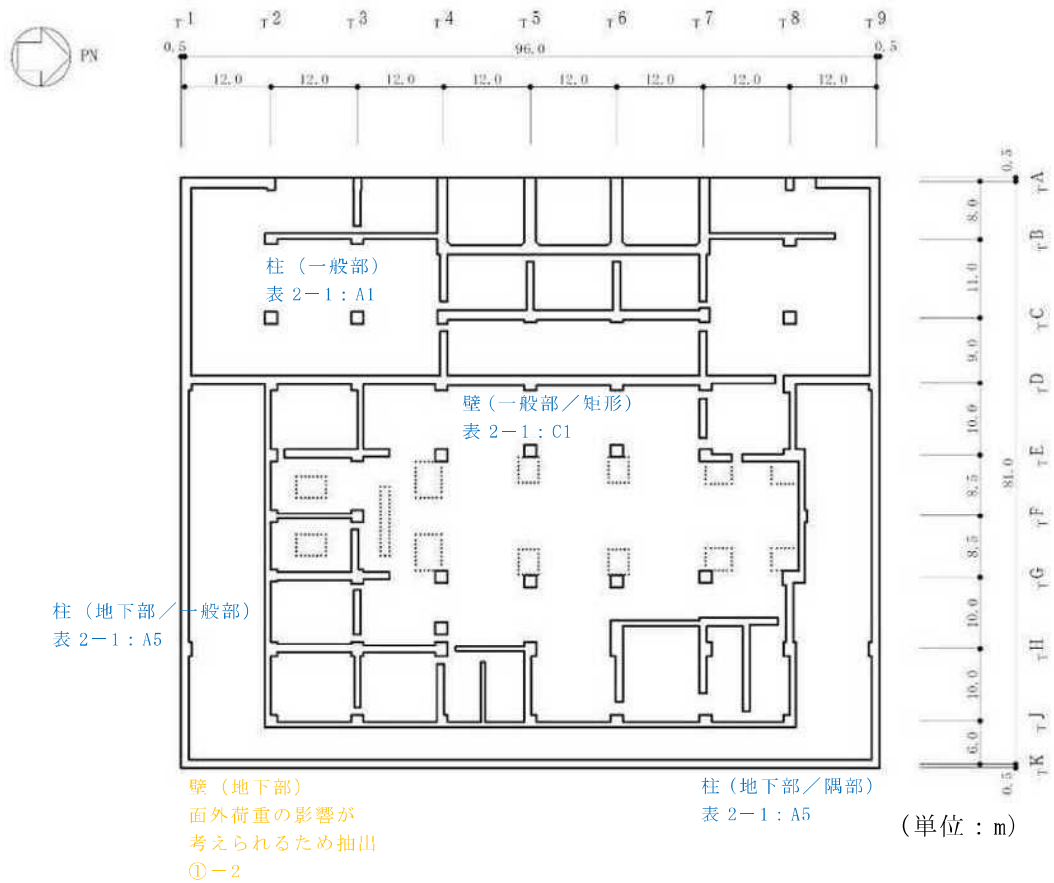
タービン建屋の概略平面図 (B2F, T. M. S. L. -5.1m) (1/5)
